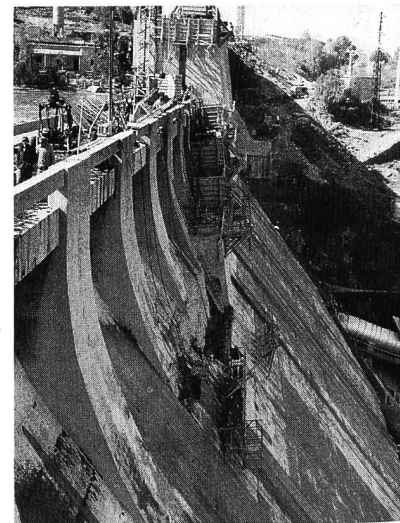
Reprise sur le parement aval. Au premier plan, la reprise de bétonnage 11 m sous le couronnement existant, puis les étapes de bétonnage de la partie inférieure. A l'arrière-plan, le barrage surélevé.
